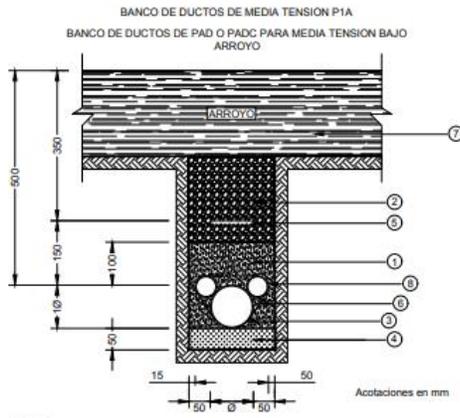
Detalle arquitectónico de la instalación eléctrica subterránea.
